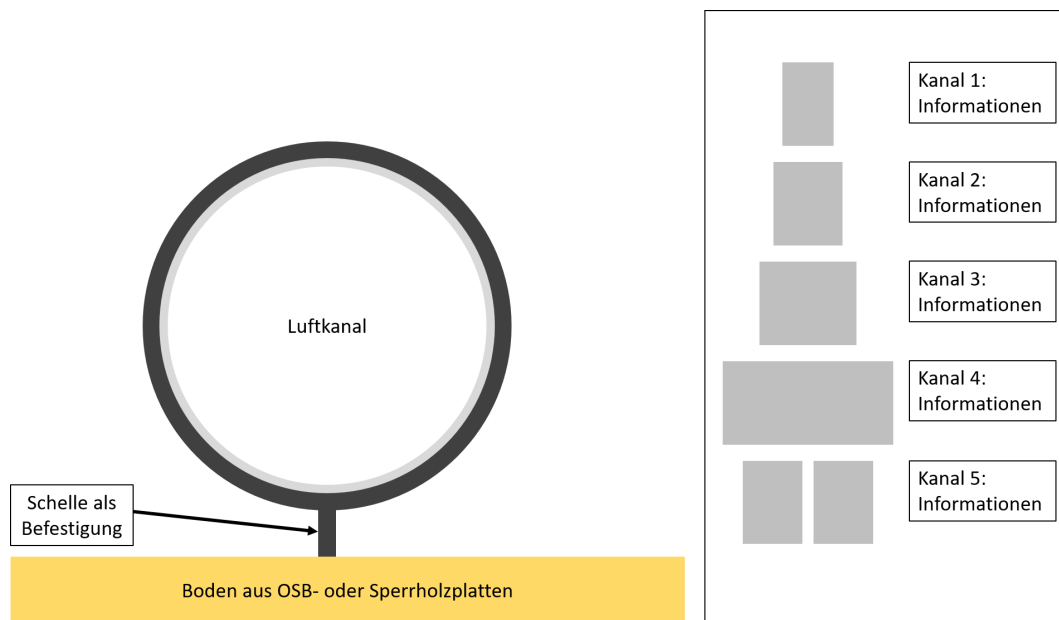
(Quelle: PHI) Links: Schnittskizze; Rechts: Skizzenansicht von vorne
